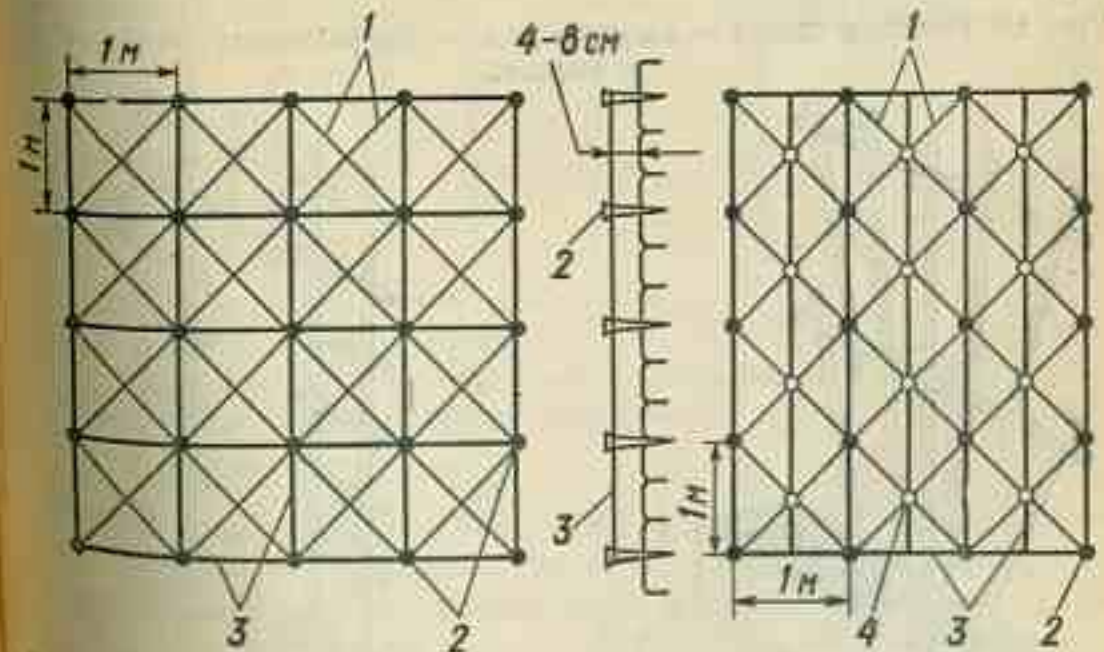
Схема конструкций наиболее рациональных опор для лиан и крепления их к стене:
